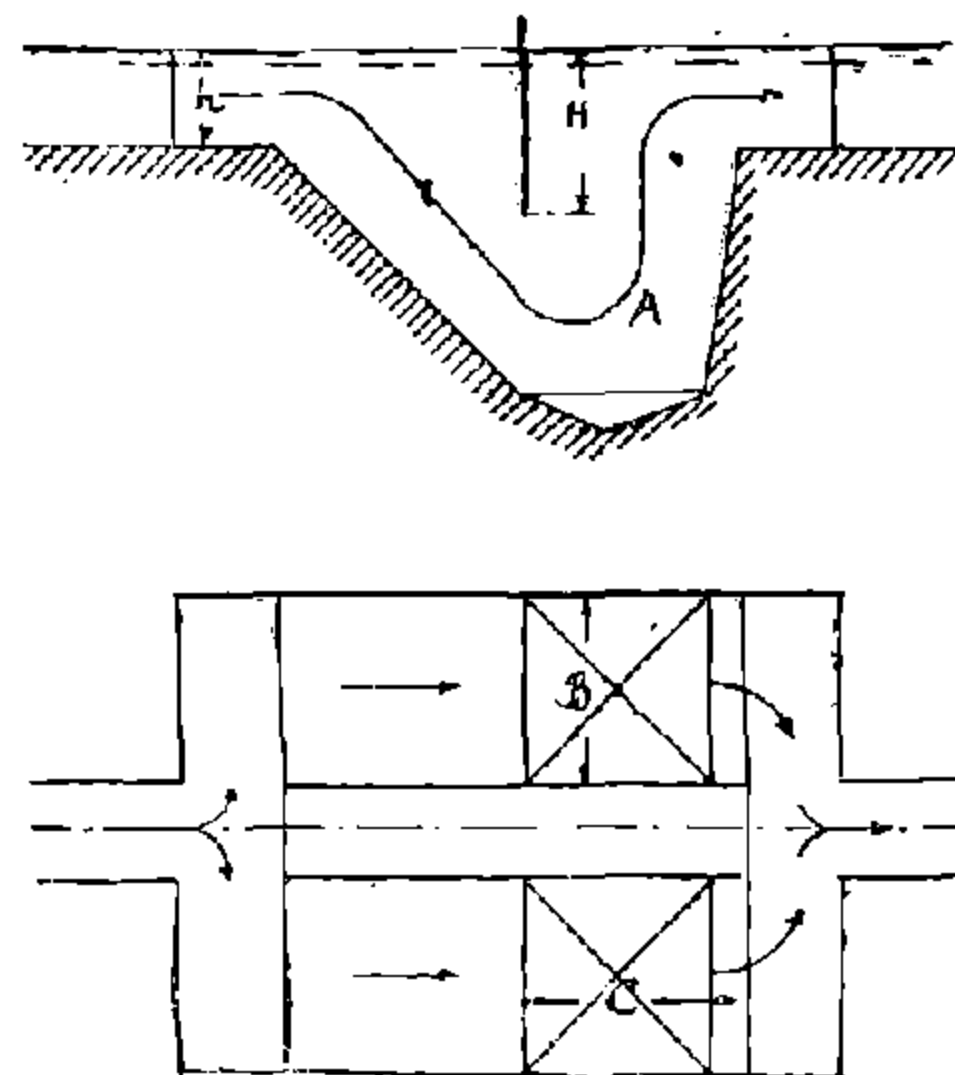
Схема вертикальной песколовки. Продольный разрез и план.
